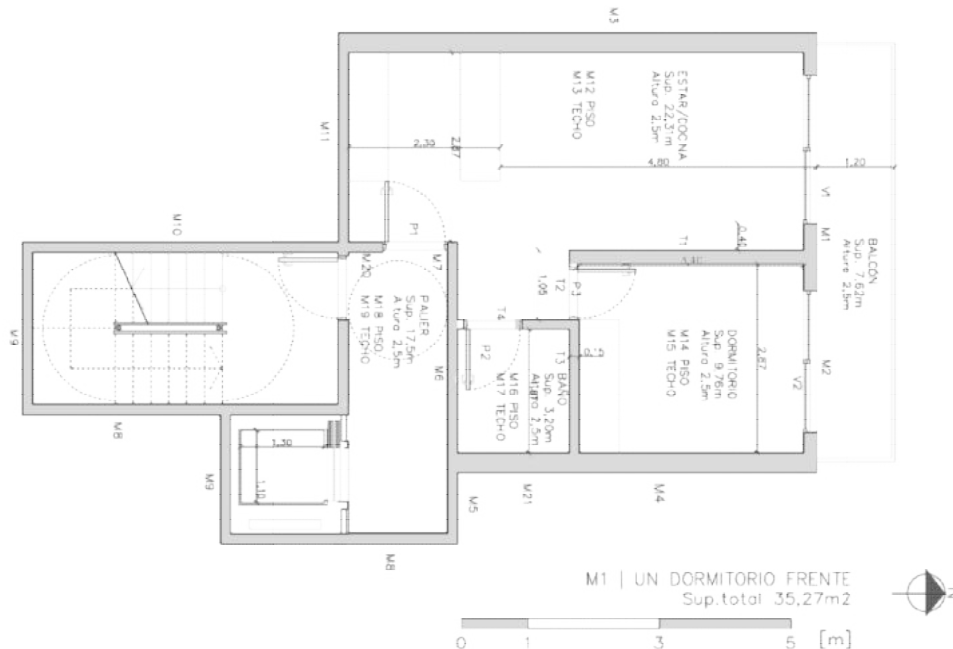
Esquema de planta del módulo M1. Fuente: Elaboración propia del equipo.
